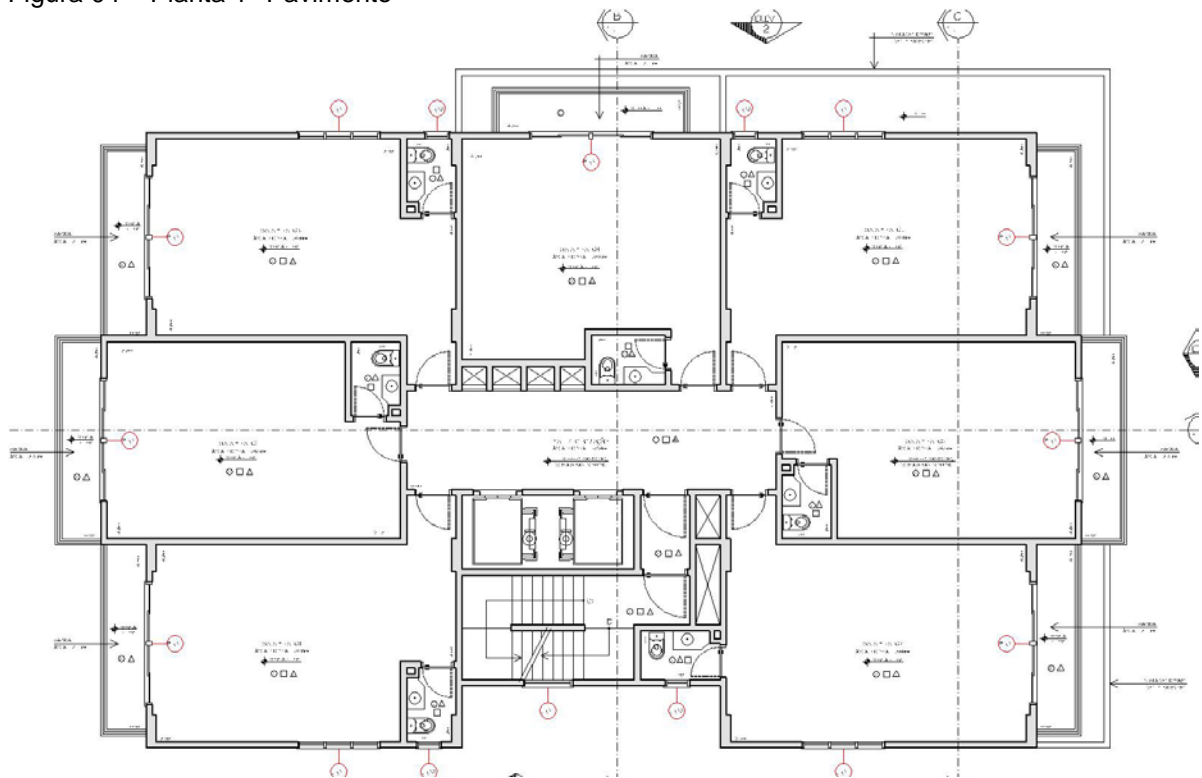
Planta Pavimento Tipo – 2° ao 6° pavimento
